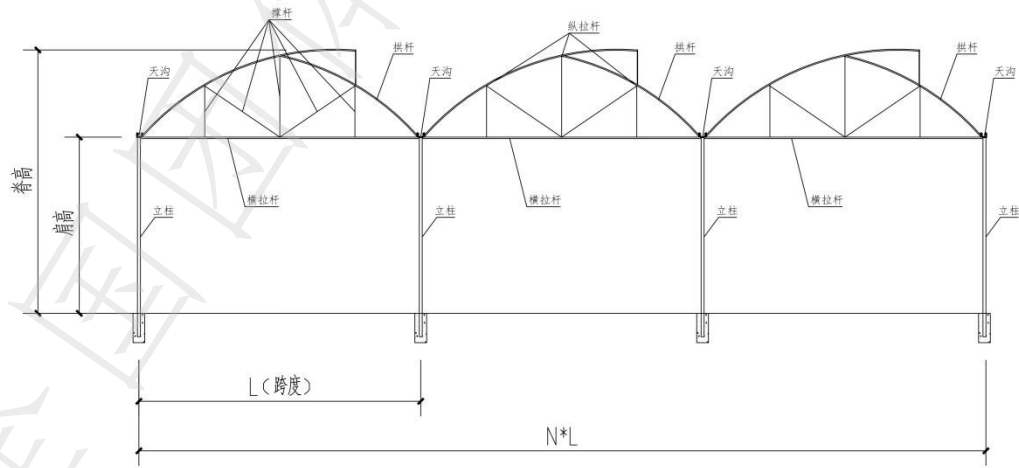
锯齿型屋面连栋塑料膜温室剖面示意图
